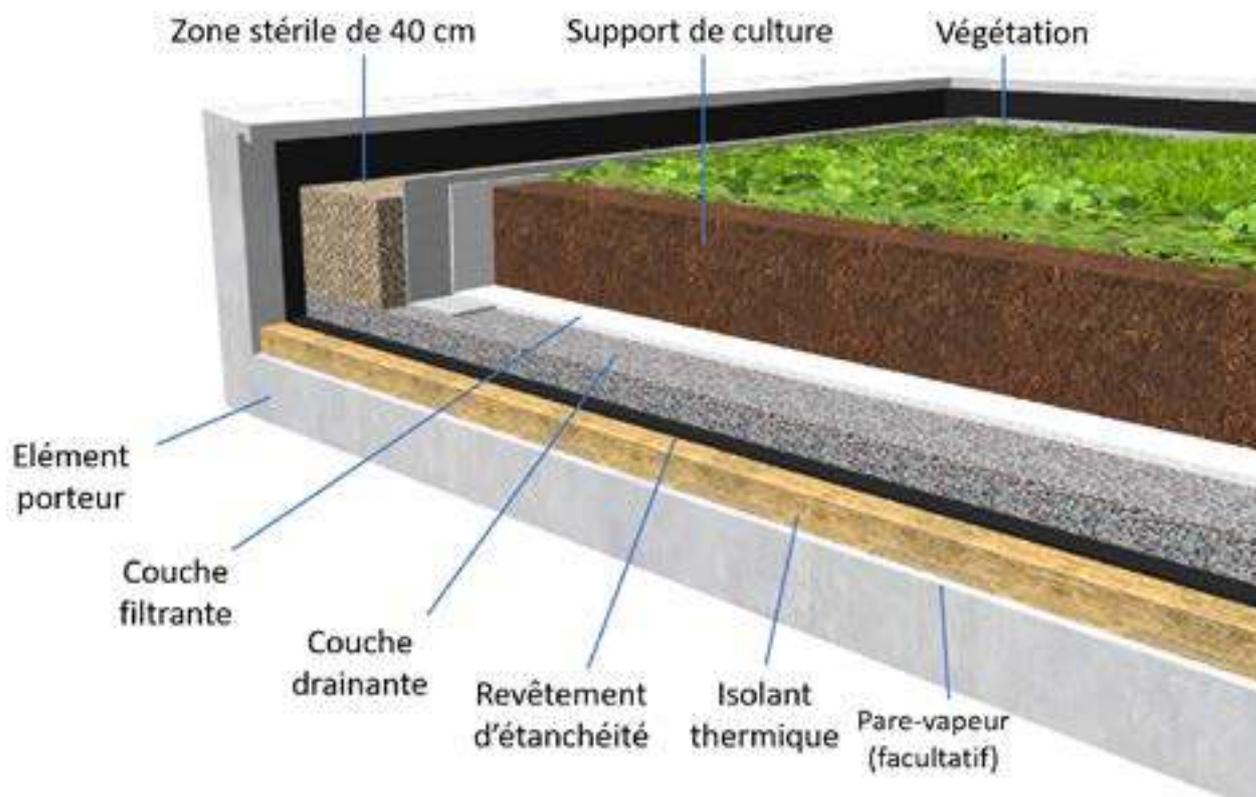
schéma en coupe d'une toiture végétalisée (dessin de Cédric Houel).
